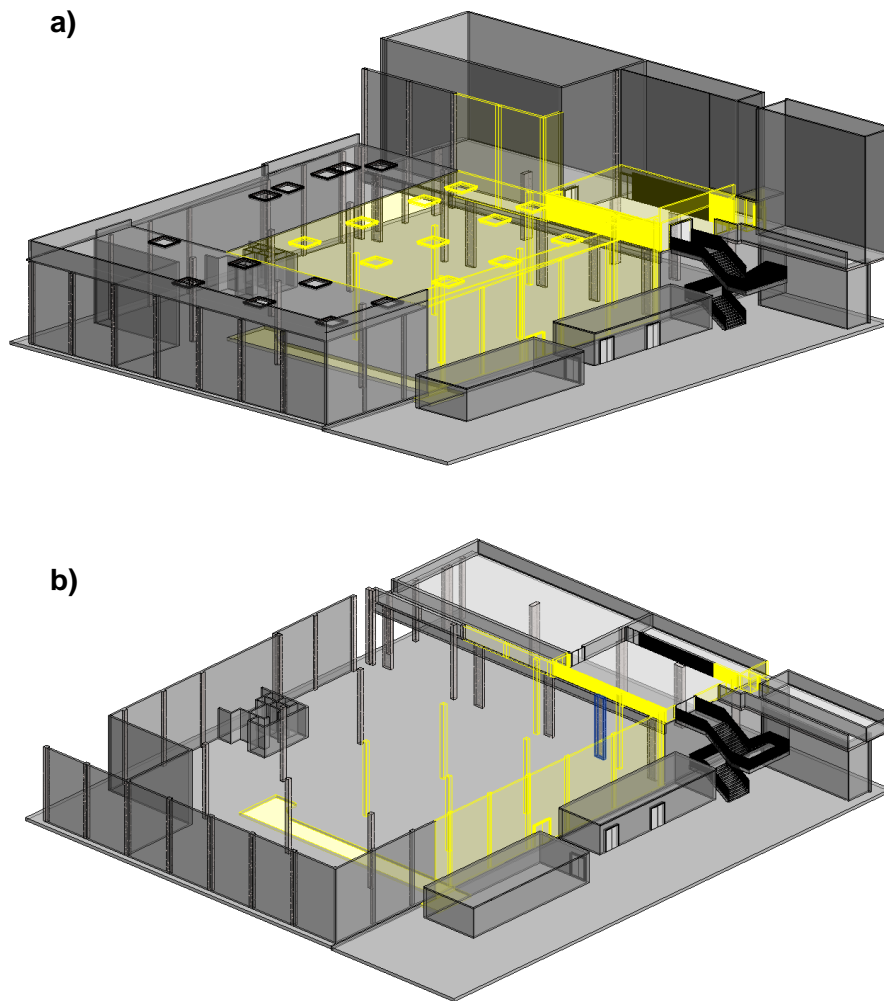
Demolições: Alçado Este; a) Vista alçado este; b) Corte Transversal
